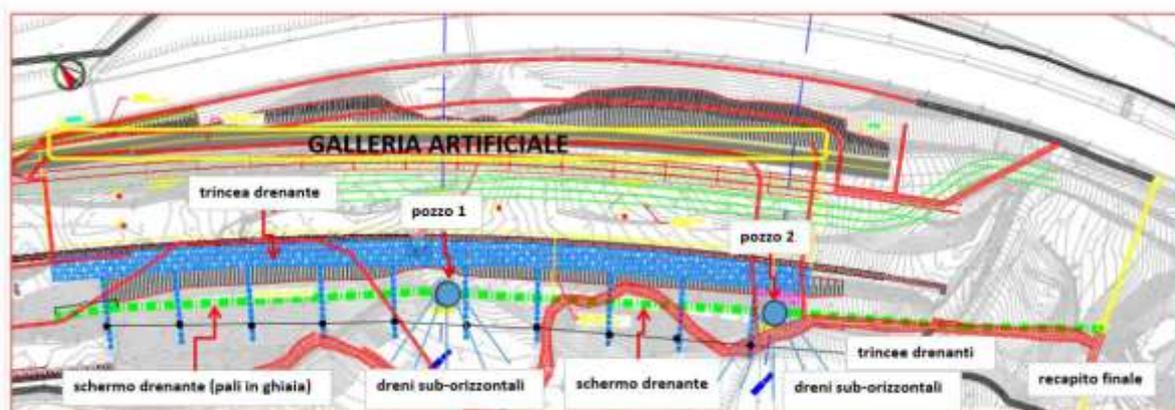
planimetria dell'area d'intervento (galleria e dettaglio sistema di drenaggio), figura tratta dalla "Relazione geotecnica".
